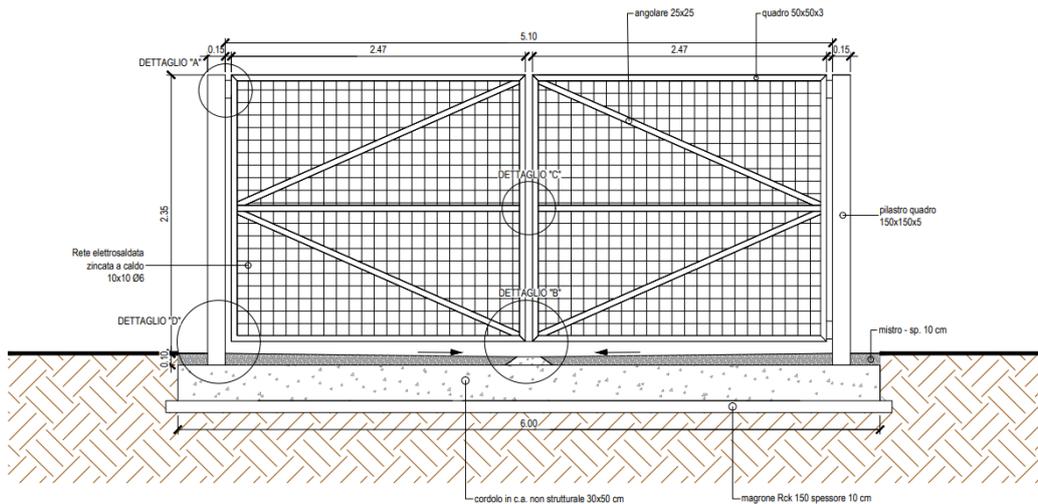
Cancellone di ingresso ai campi fotovoltaici, schema tipo (estratto PRO\_TAV\_23).
